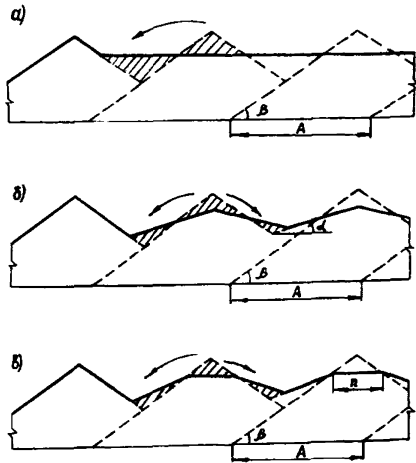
Расчетные схемы к определению объемов земляных работ при планировке гребневидных отвалов и создании поверхности: а – плоской; б – волнообразной; в – с горизонтальными площадками.
